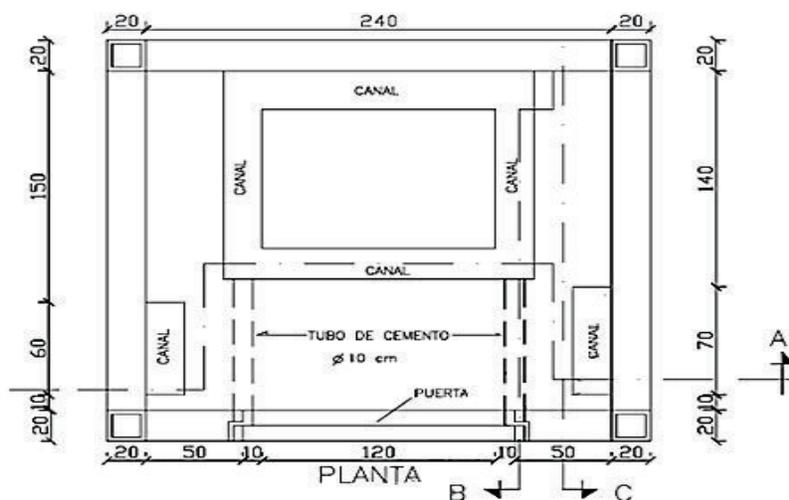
Obra civil – disposición y dimensiones generales.
